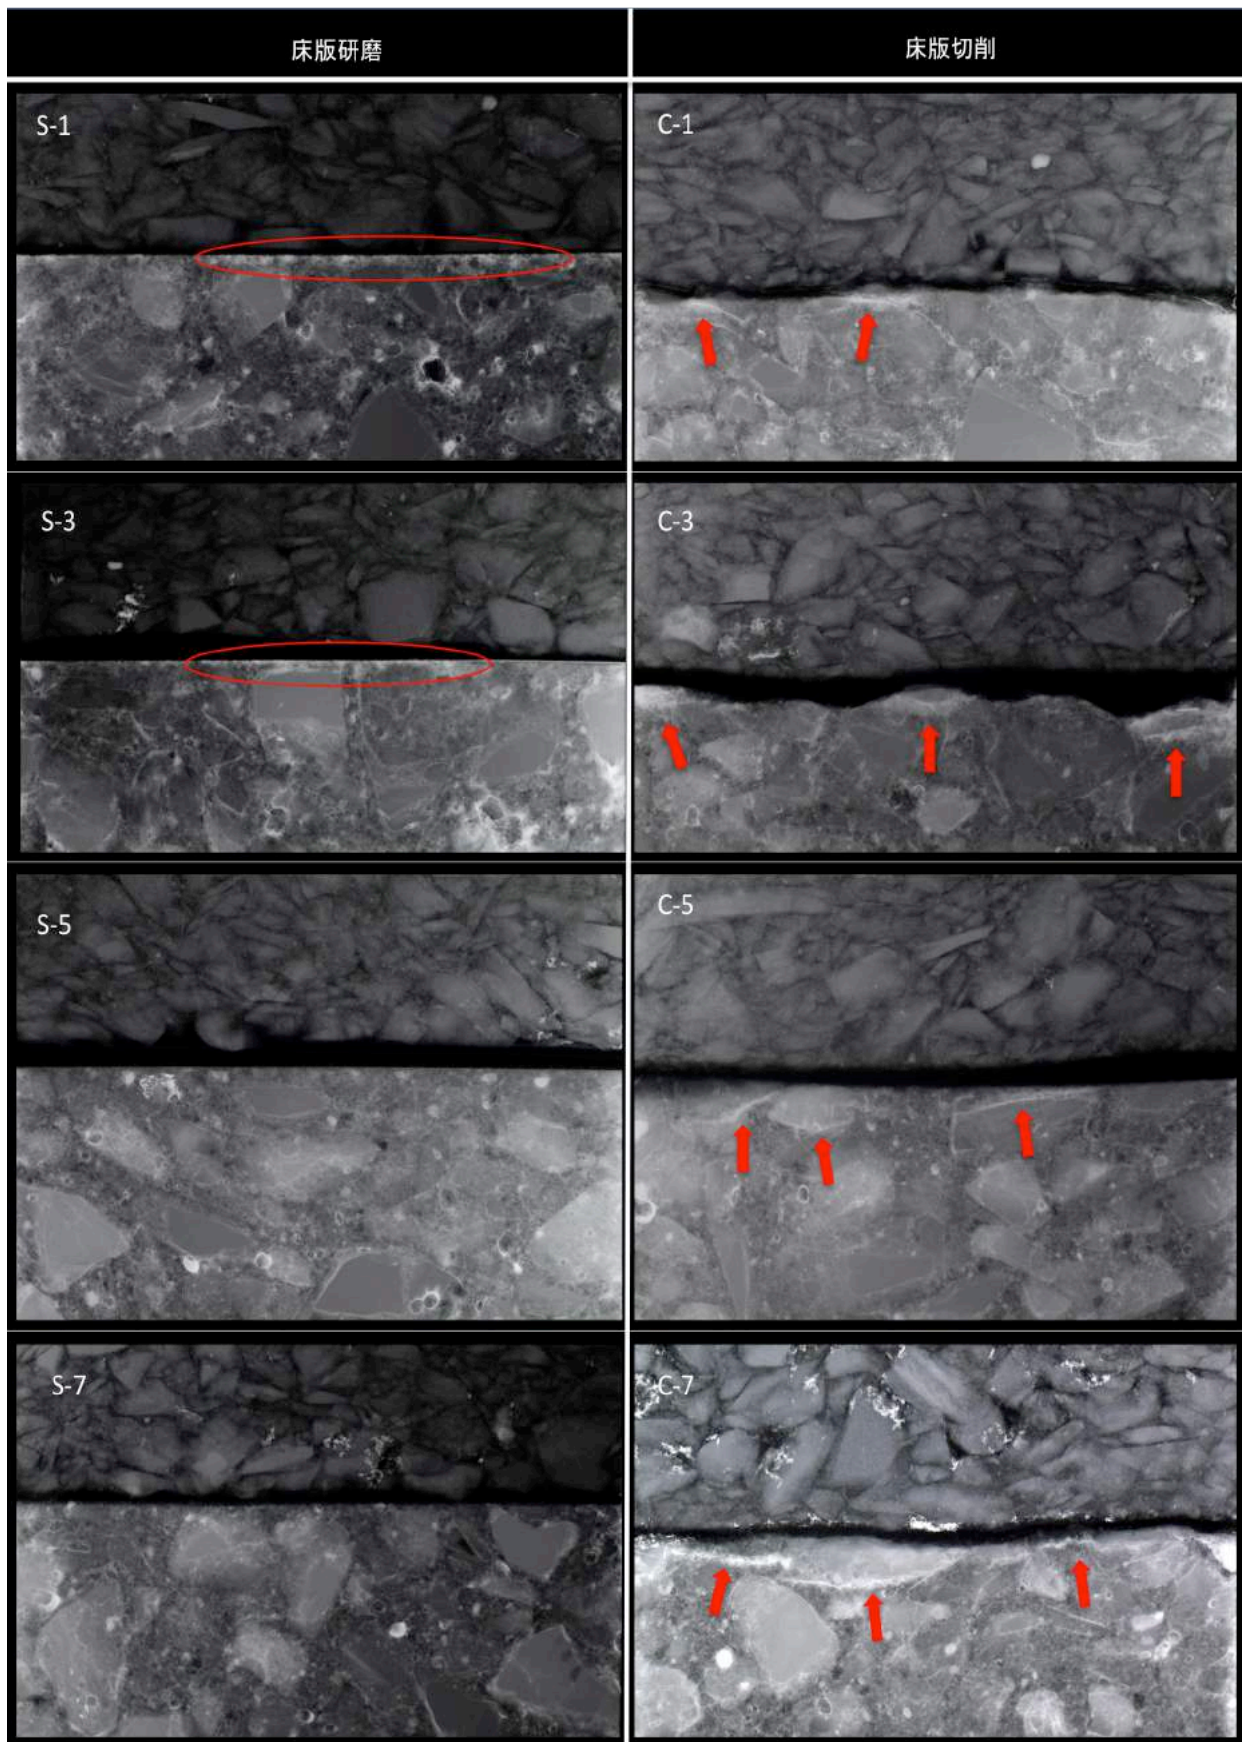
疑似床版・防水工・舗装周辺のひび割れ状況（X線フィルム画像）
